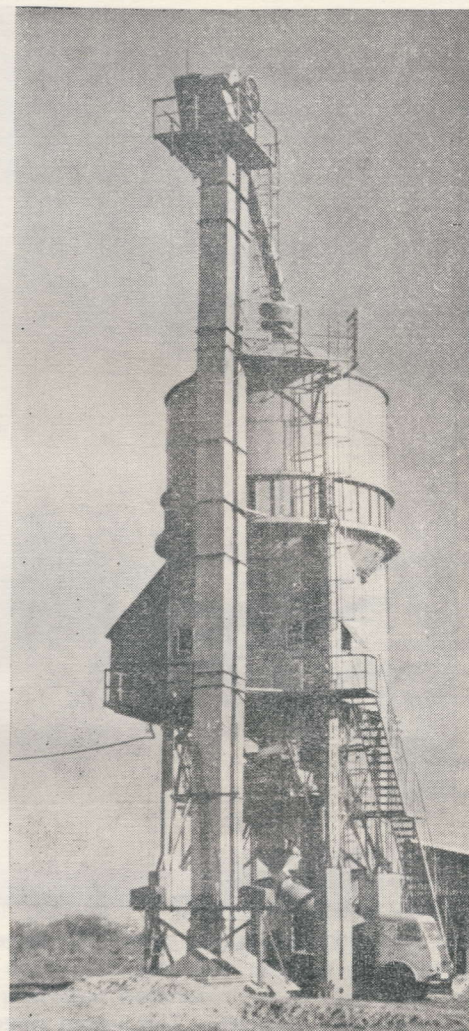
Montaža betonare — kranom. U pozadini separacijski toranj
